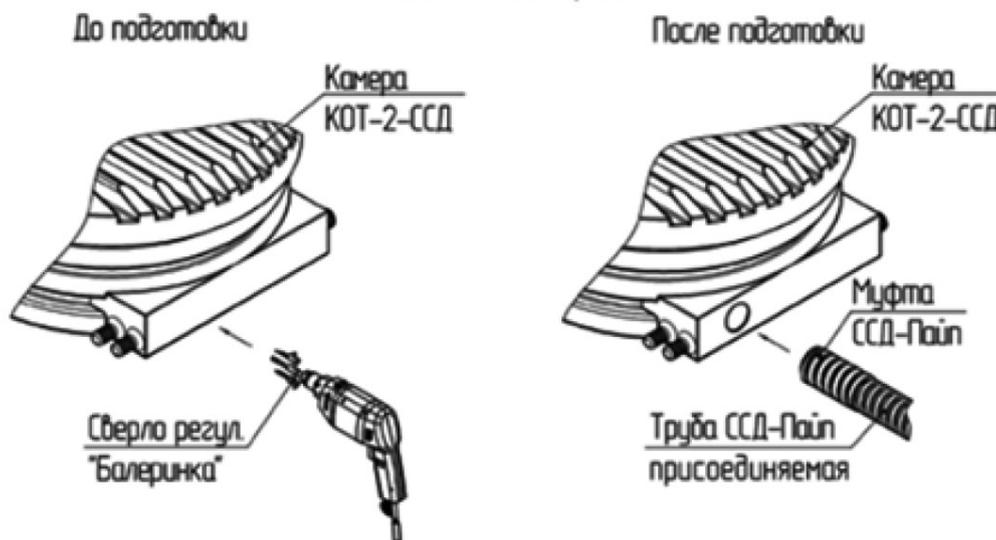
Схема установки камеры оптической КОТ-2-ССД
